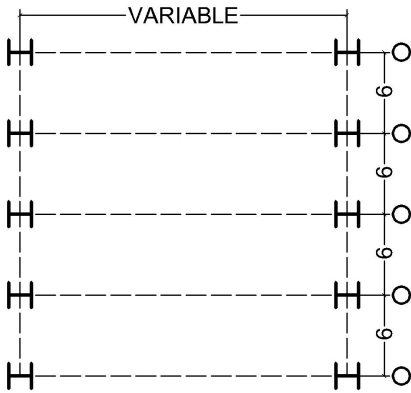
Planta de modulación, lado corto 6 metros que corresponde a las medidas estándar de las piezas de acero.
